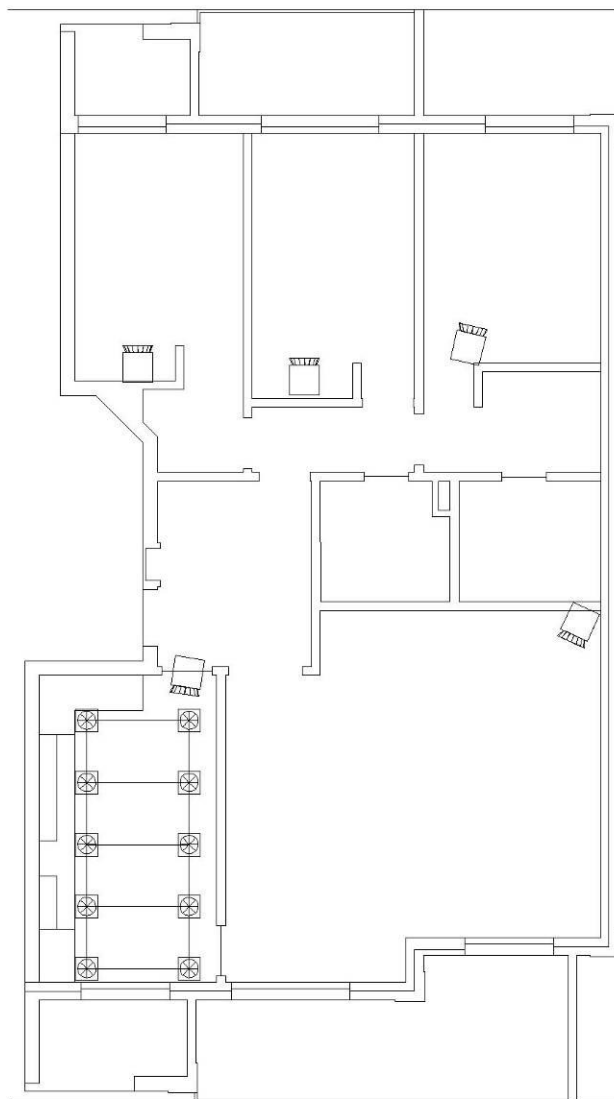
Posição (em planta) das câmaras e da malha de pontos
